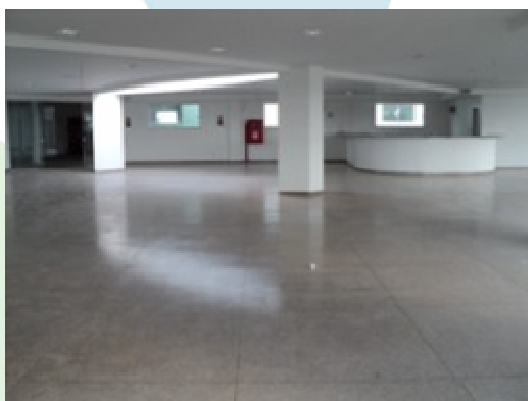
Construção da Policlínica Oswaldo Cruz (Out12)
